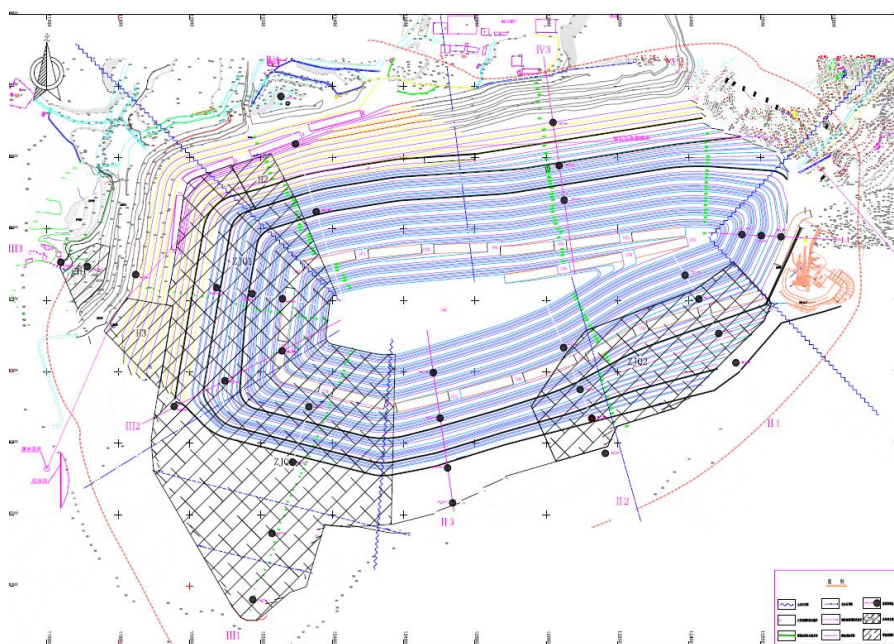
露天采场终了边坡控制监测点位置建议平面图
